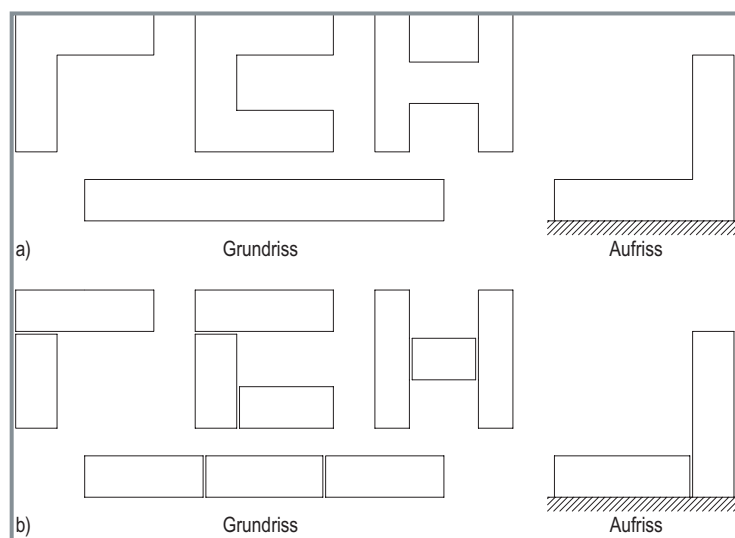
a) ungünstige Grundrisse b) Verbesserung durch statische Unterteilung
